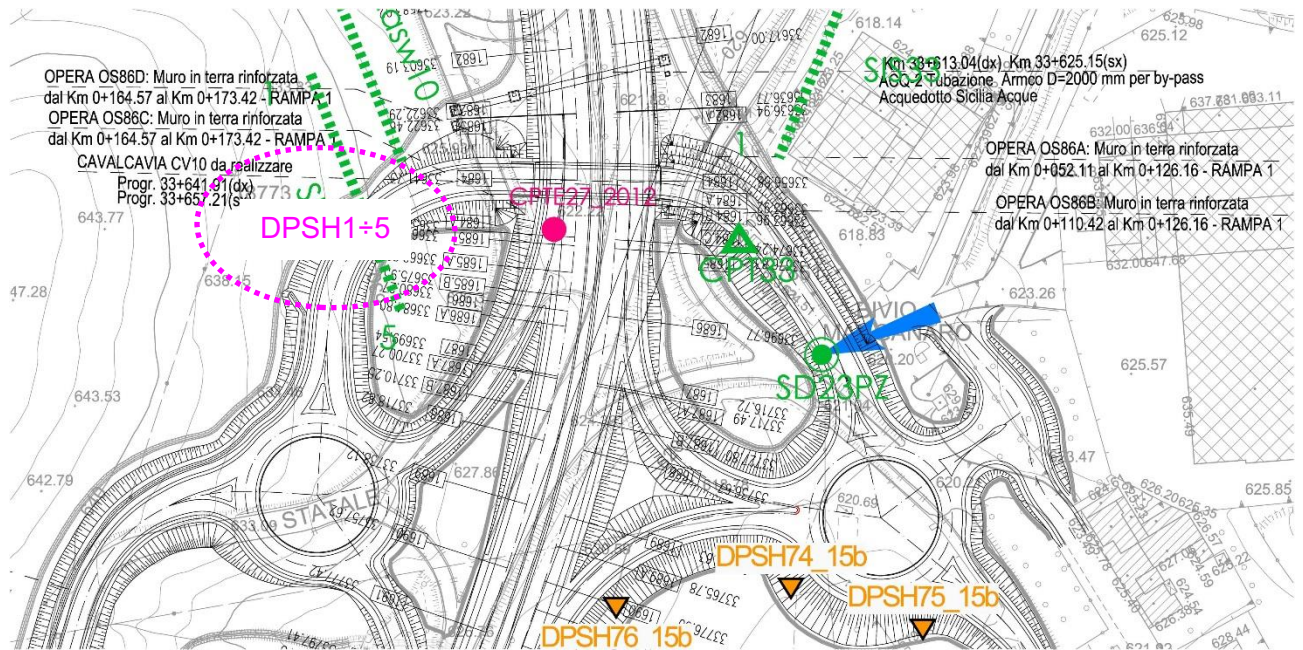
Planimetria con ubicazione indagini geotecniche disponibili nell'area del Bivio Manganaro
